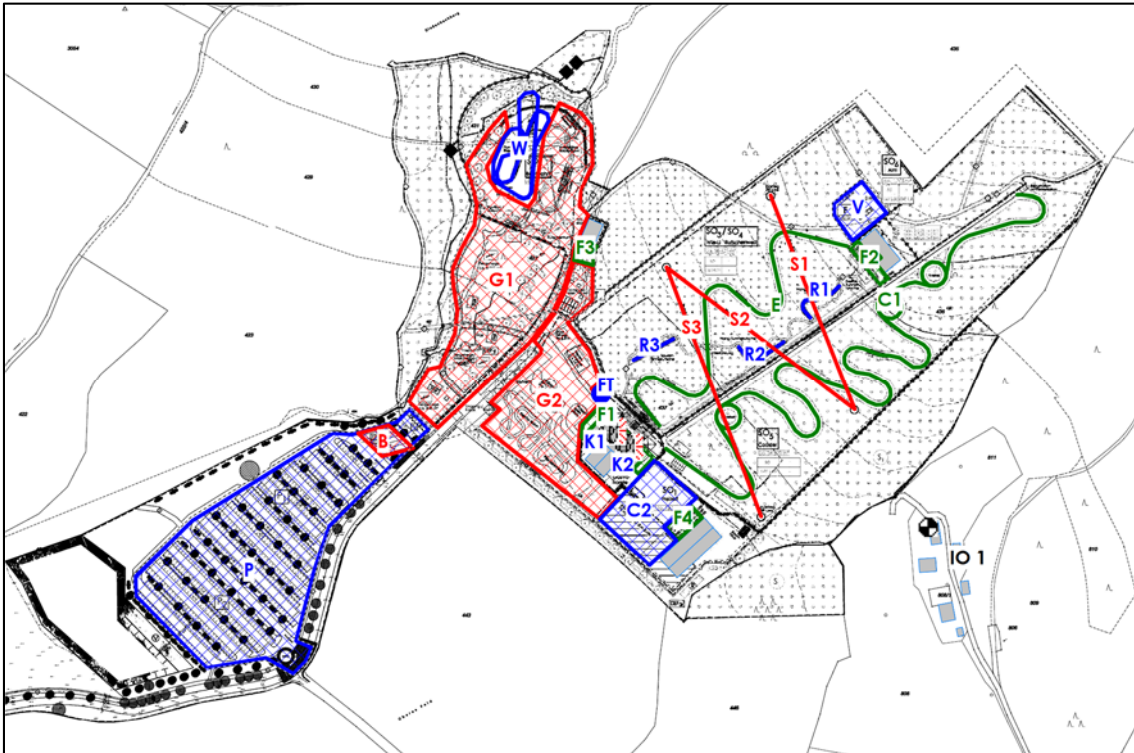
Lageplan mit Darstellung der Schallquellen
